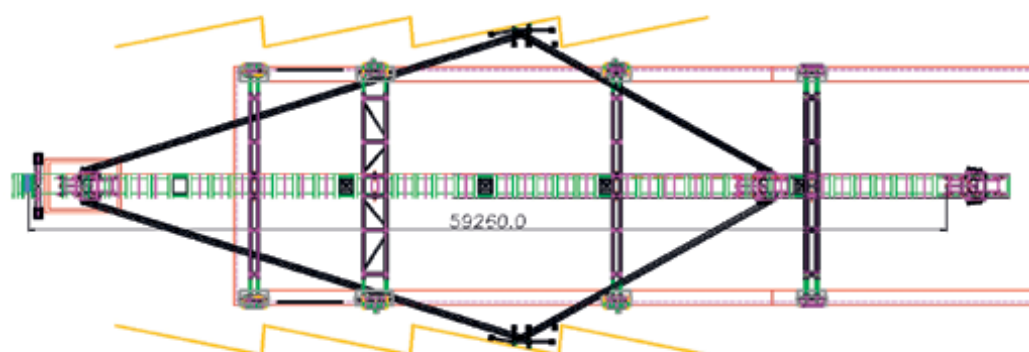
Vista dall'alto del progetto definitivo dell'impianto di impatto ad alta velocità
